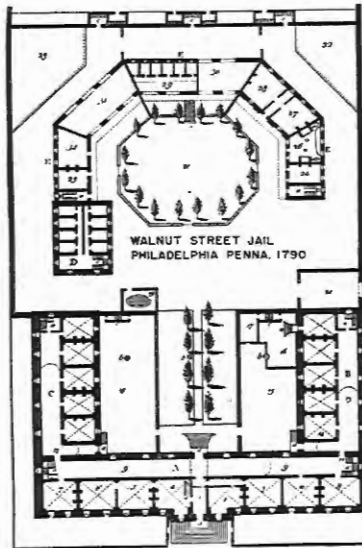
Planta da cadeia Wanut Street, Filadélfia, Pensylvania, 1790. Fonte: Handbook of Correctional Institution Design and construction, p. 23.
